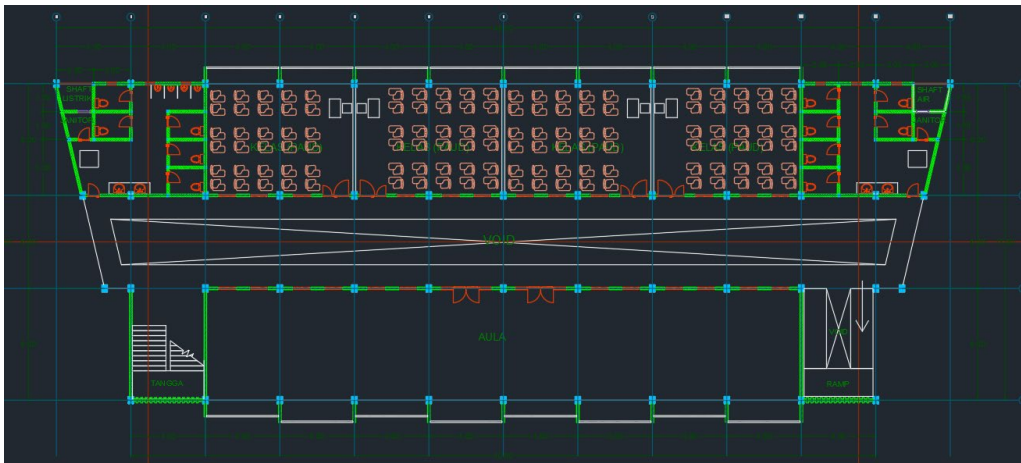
7 denah Lt 1 bangunan kampus Stital.
